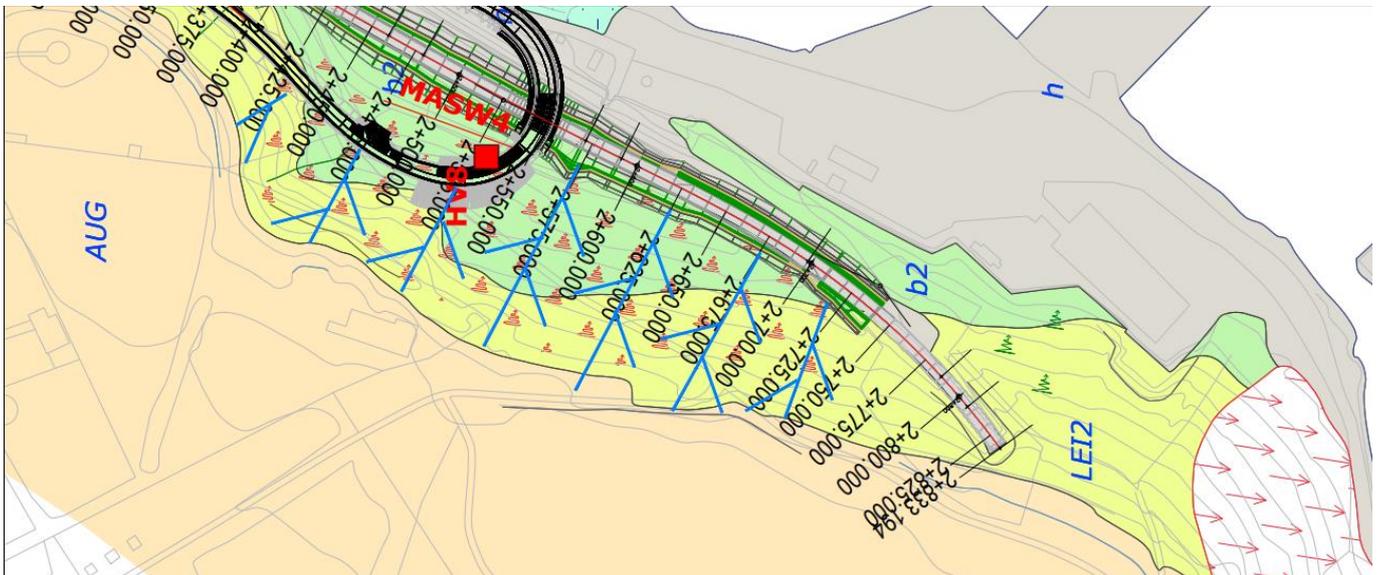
Ubicazione delle trincee drenanti previste per la stabilizzazione dei versanti soggetti a dissesti
